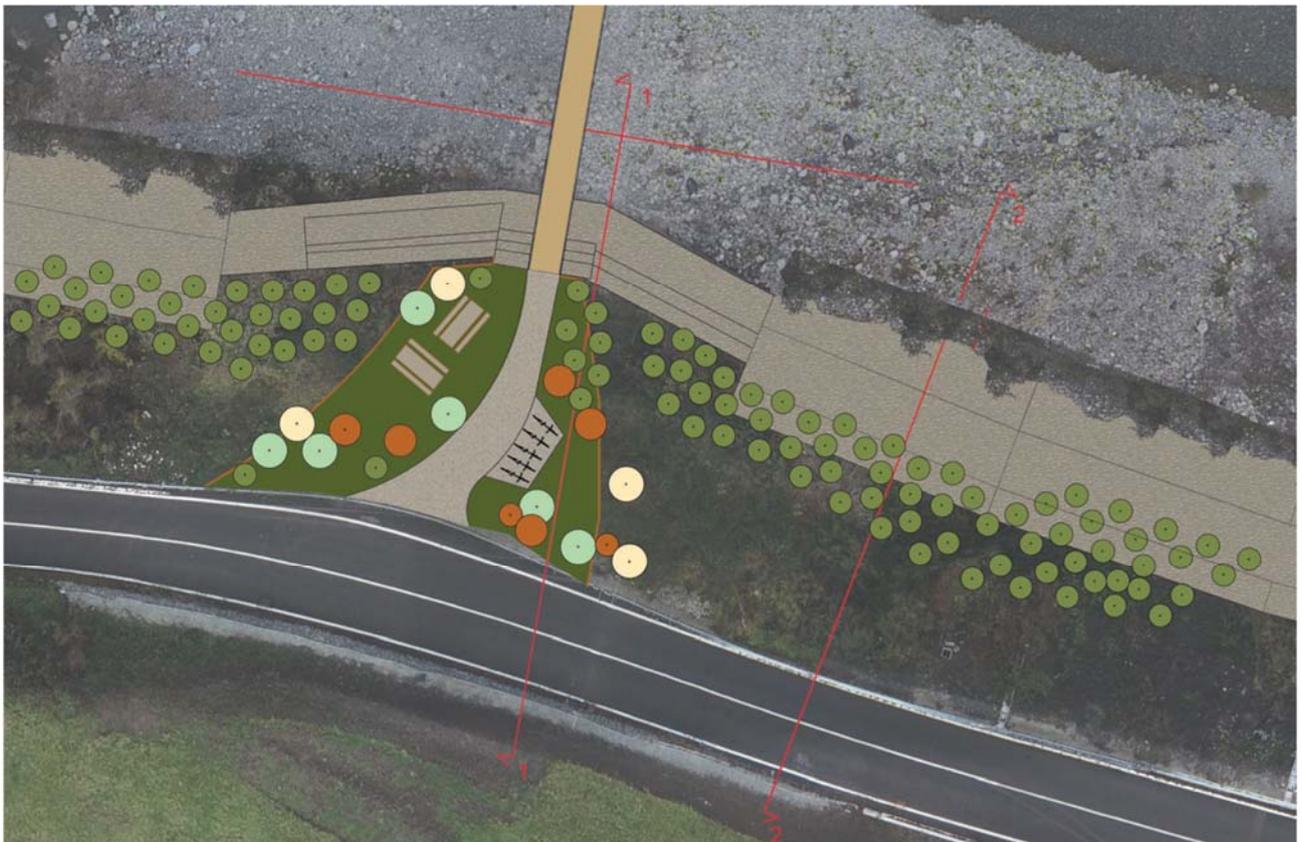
Pianta dell'area picnic lato Genova con testa del ponte pedonale
